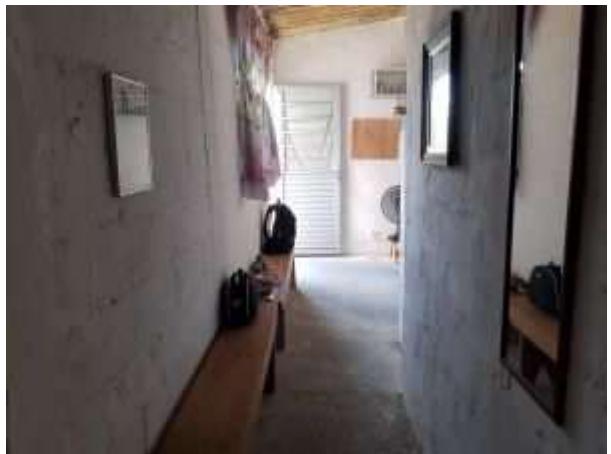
CORREDOR CIRCULAÇÃO
